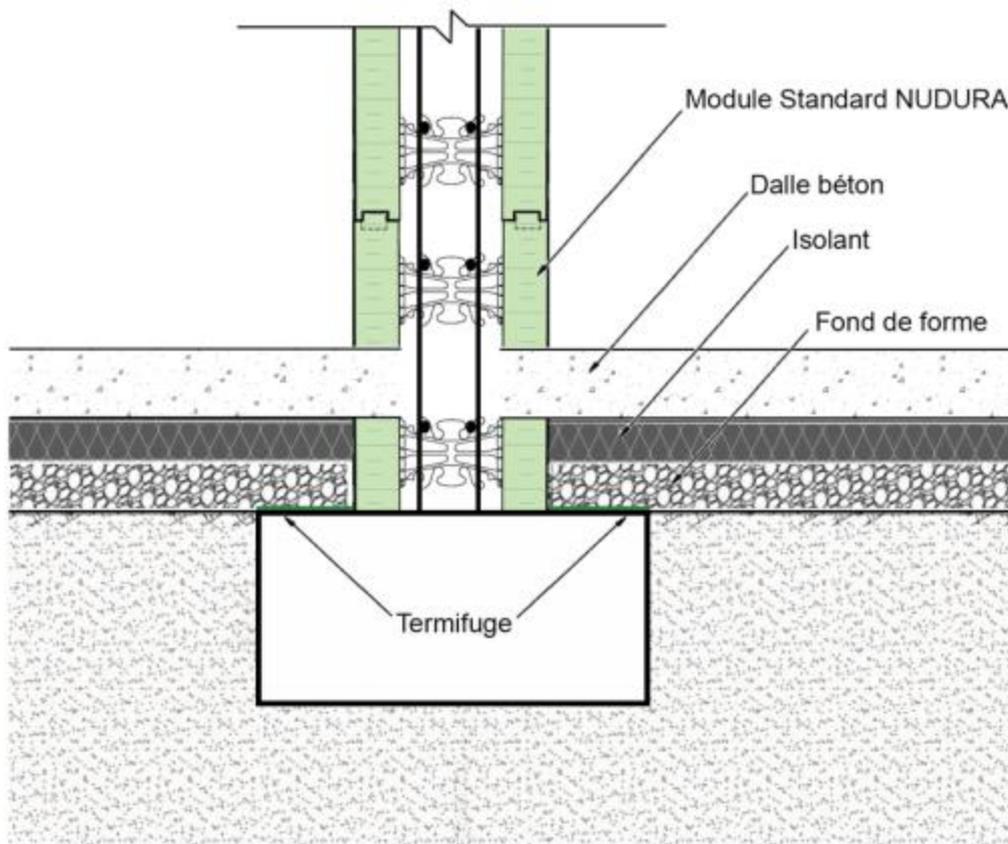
Traitement termite –Dallage sur terre-plein isolé et porté
